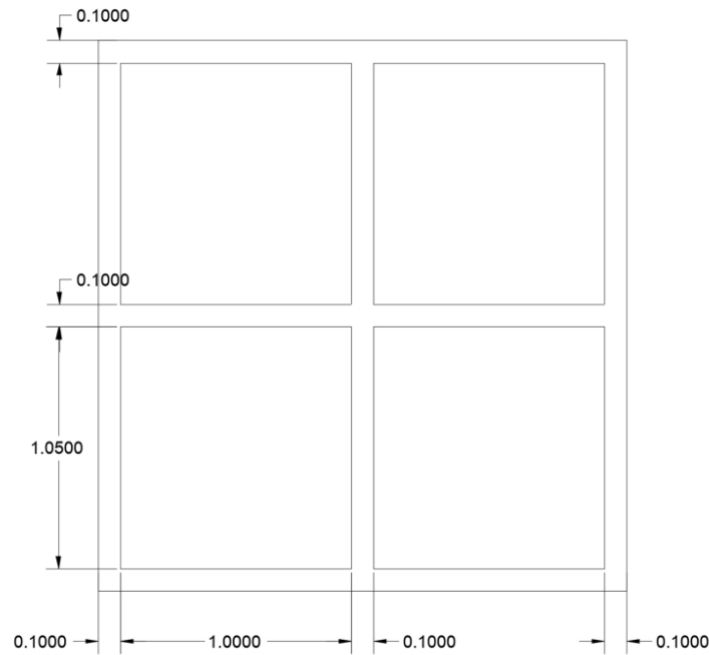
Vista en planta de las dimensiones y separación entre cada bloque. (Elaboración propia)
